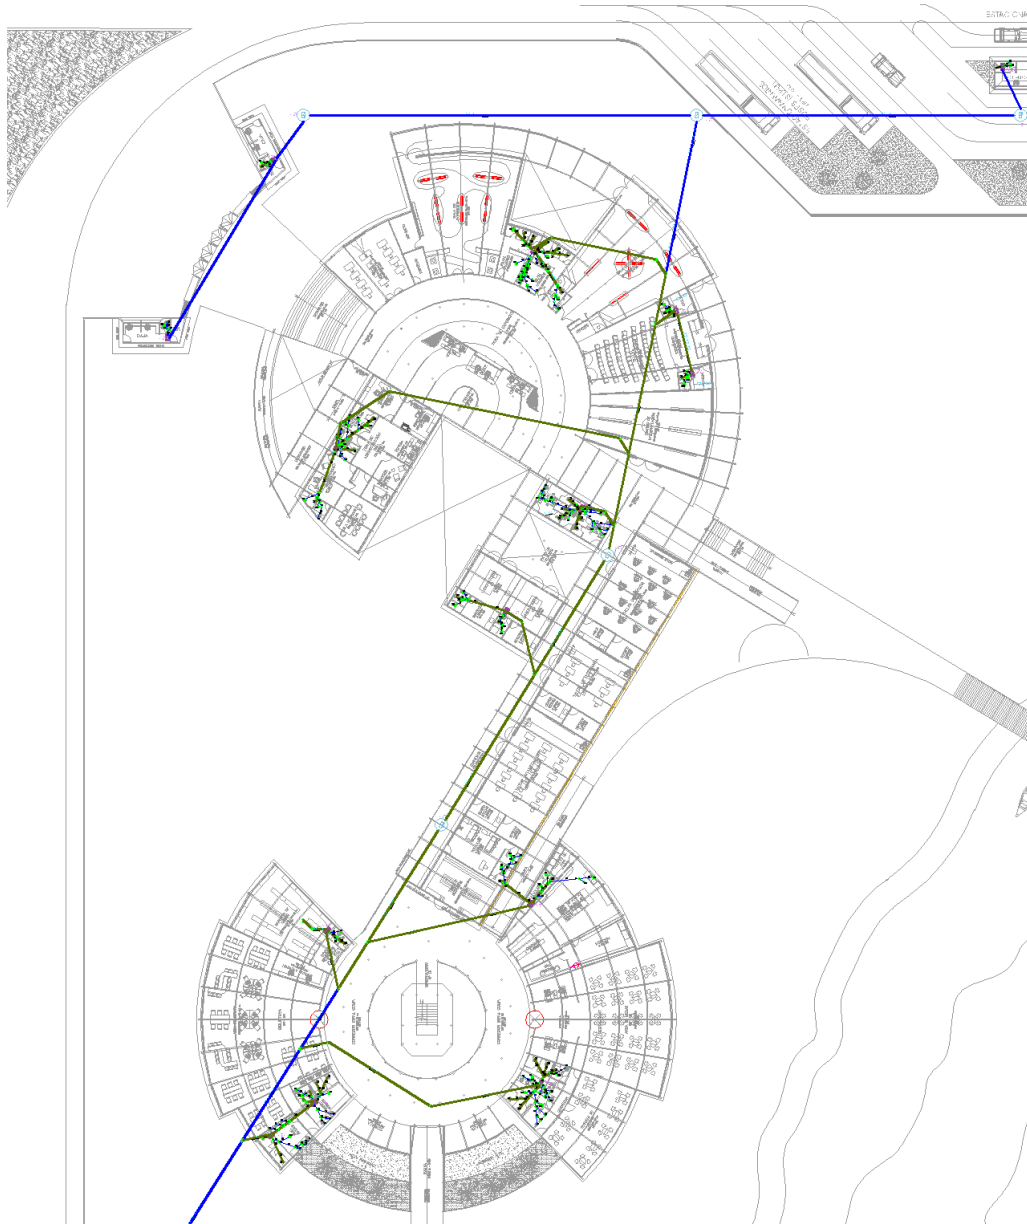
Plano de instalaciones sanitarias-desagüe primer bloque
